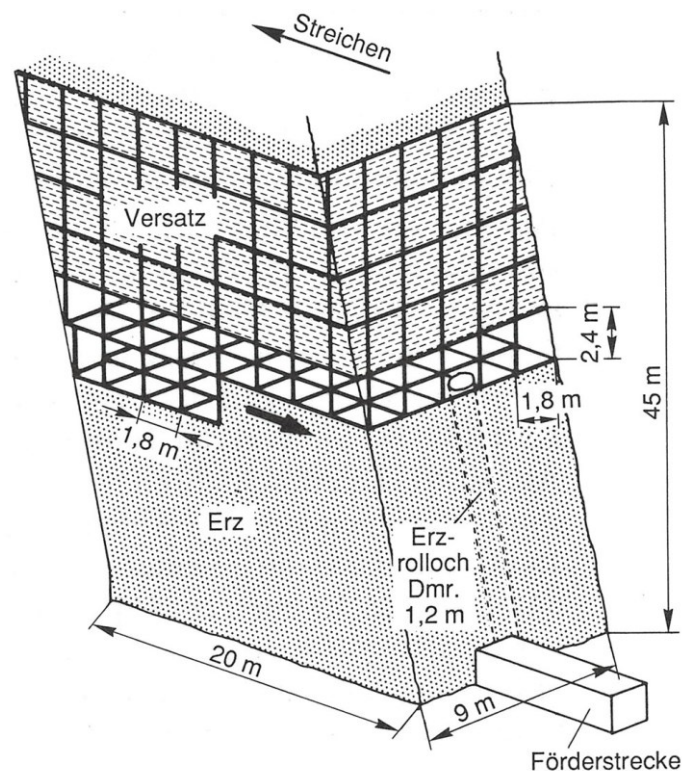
Abwärtsgeführter Blockbau mit Gerüstzimmerung und Versatz
